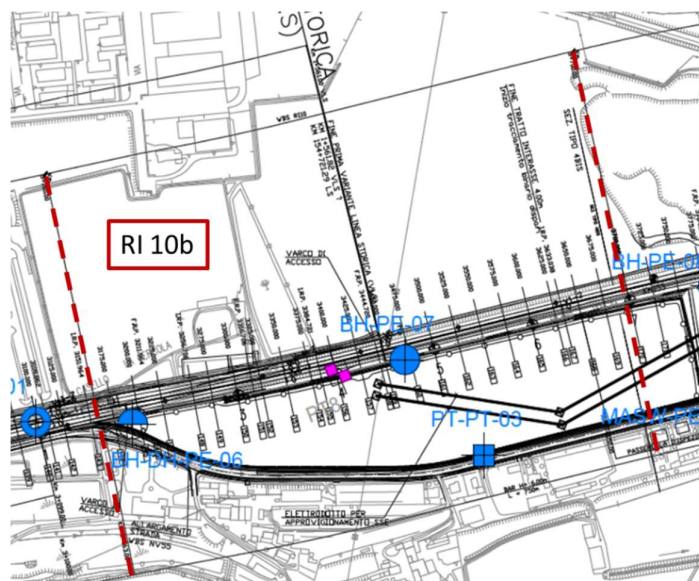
Planimetria Rilevato RI10B, estratto dalla Planimetria Generale (Doc. Rif. [3])
